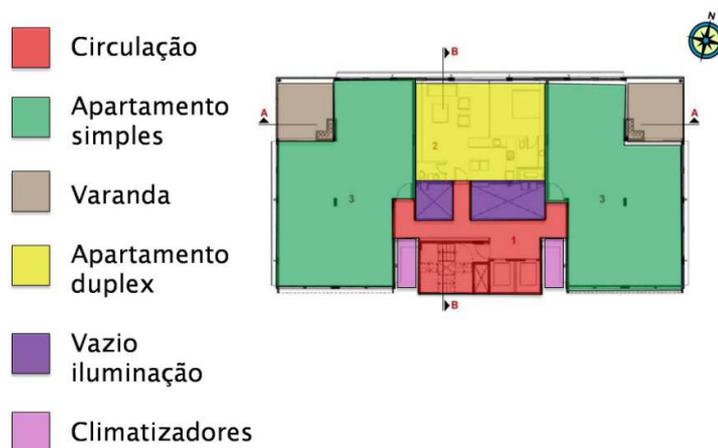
Planta baixa do pavimento tipo do edifício 4x4, projetado por Gui Mattos, em São Paulo. Adaptado de: <http://www.arcoweb.com.br> Acesso: 10 mar. 2010.
